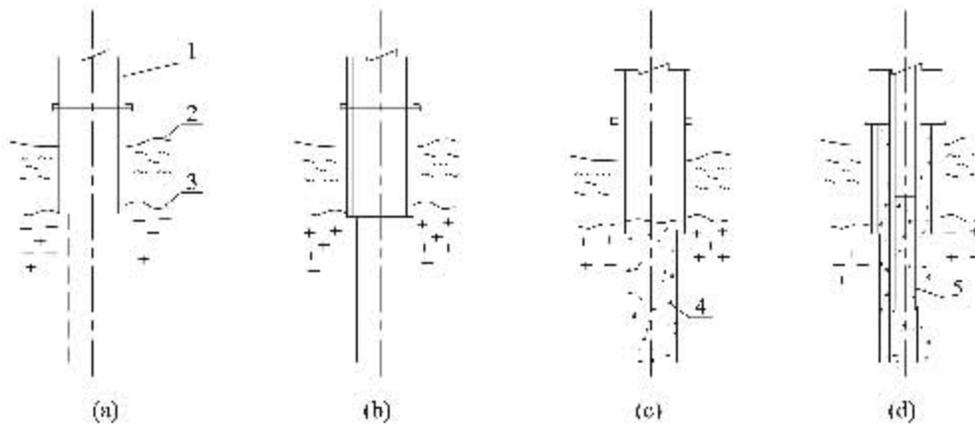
预制型植人嵌岩桩挤实锚固法施工示意图
